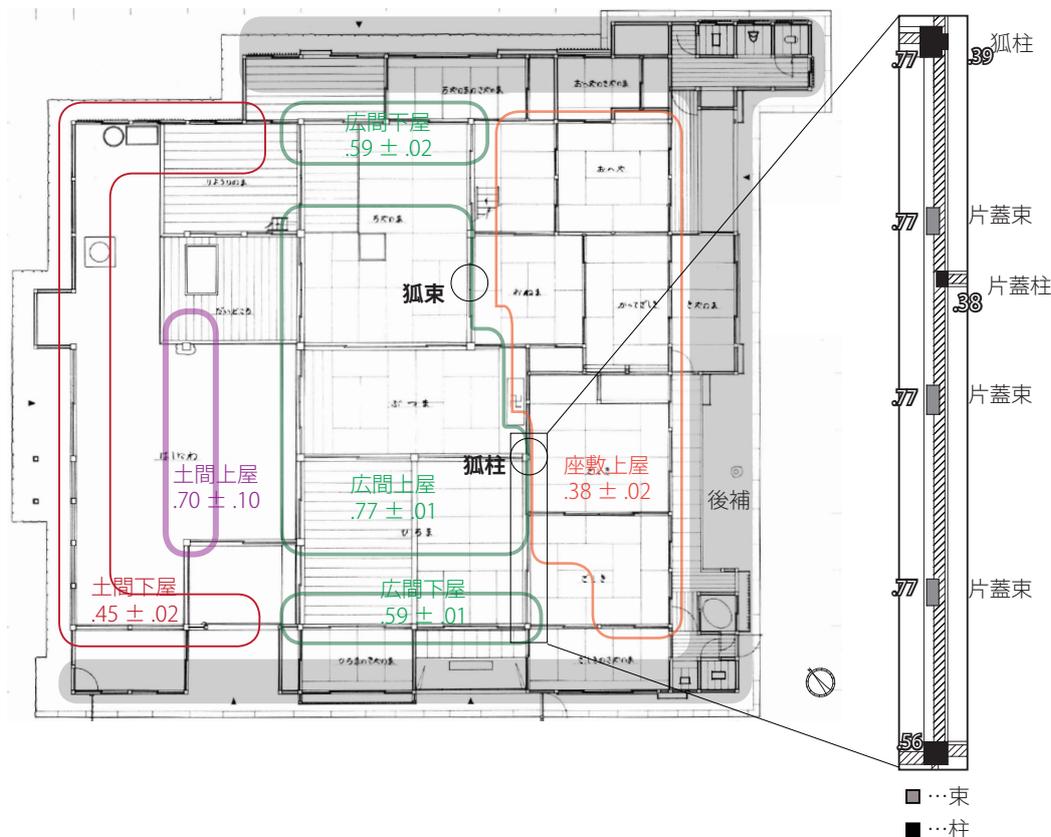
武田家平面図に柱幅書き込み（富山,報 077 引用加筆,寛政）左は平面図、右は垂れ壁の高さで切った平面詳細
